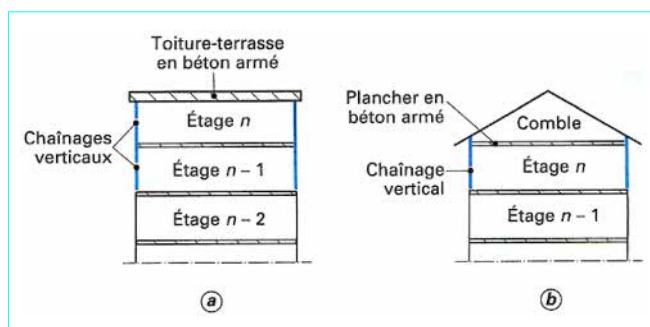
Implantation des chaînages verticaux (coupe verticale)
